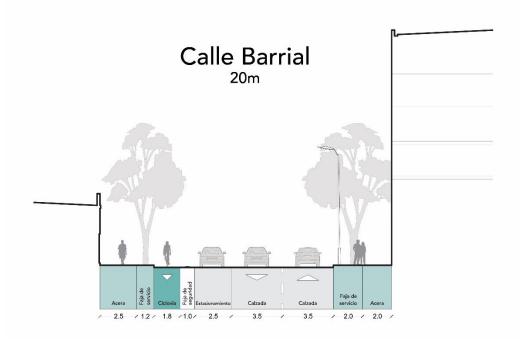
Guía de diseño para Ejes vecinales (Perfil vial: 20 m)
